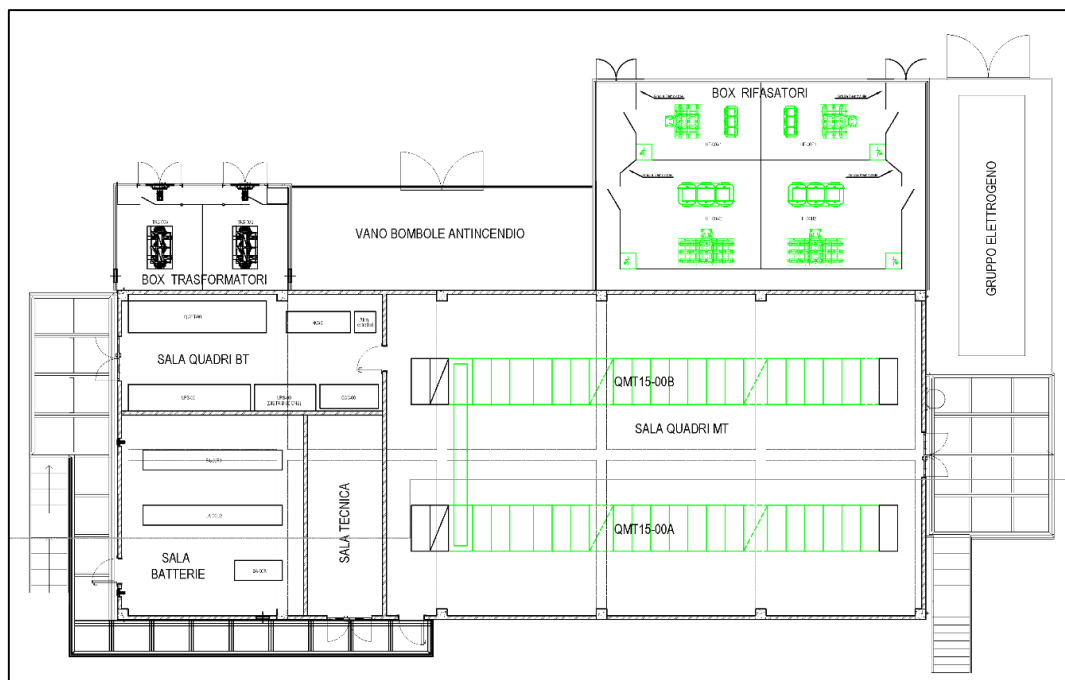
Cabina elettrica LSCT Ravano – Layout apparecchiature (21 08 PE TP04)
